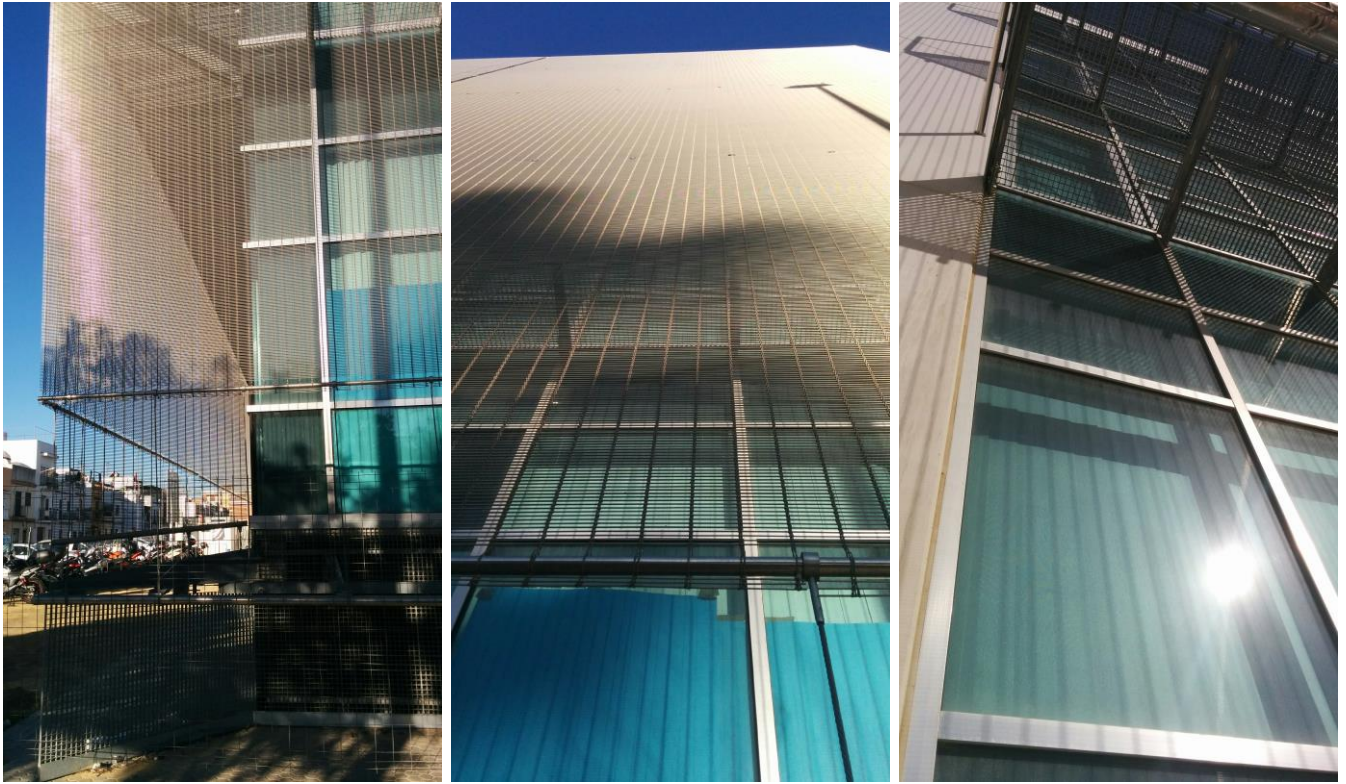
Tres vistas exteriores de las fachadas sur y este con la malla
